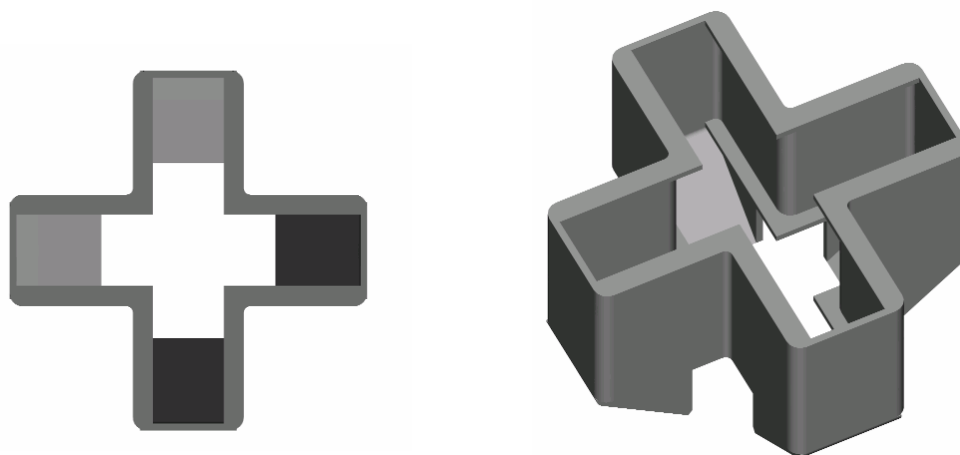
Planta y axonometría del nudo superior para malla de módulo semiocetaédrico.
